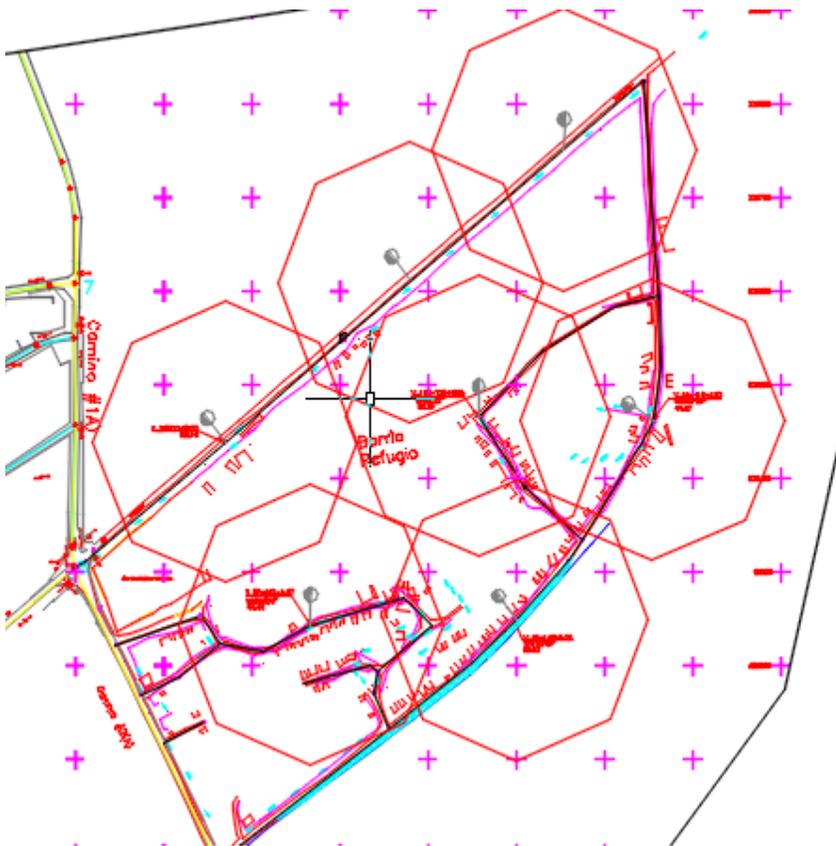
Plano de localización de los hidrantes en el barrio el Refugio.
